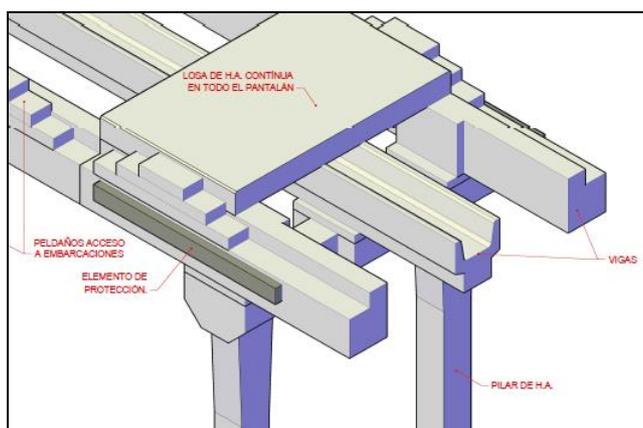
Vista 3D de la estructura del pórtico, vigas longitudinales y tablero
